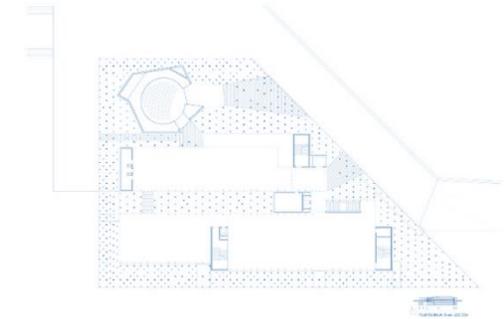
Planta arquitectónica del pabellón donde se puede observar la composición de columnas que hace de bosque vertical.
